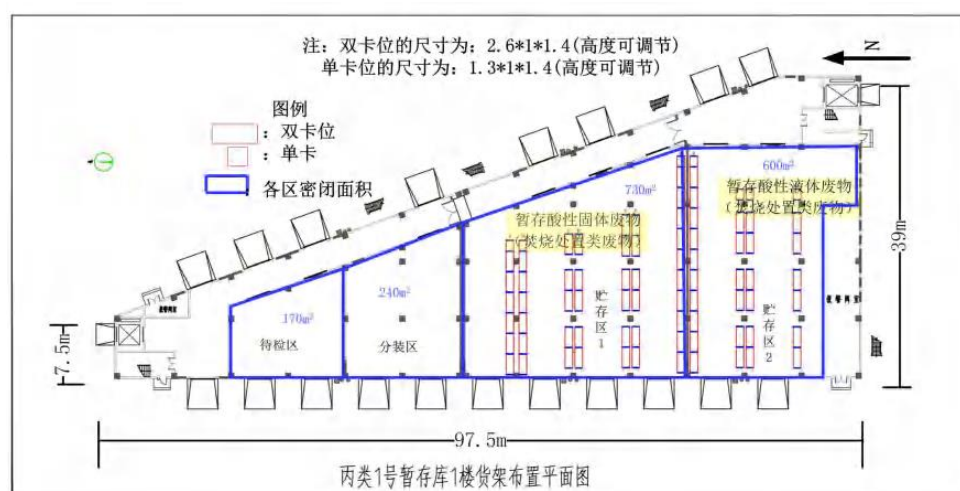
现有项目 1 号丙类暂存库 1 楼平面布置图
